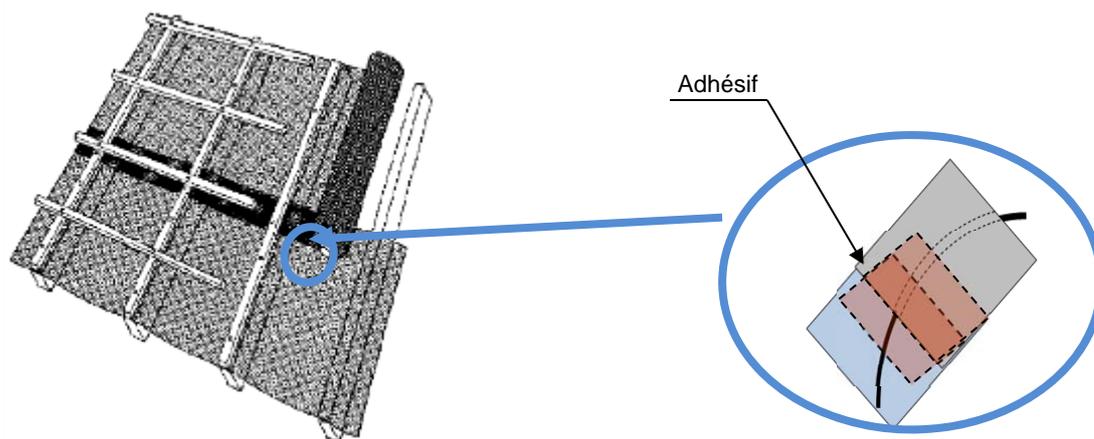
Passage des câbles au travers de l'écran de sous toiture
